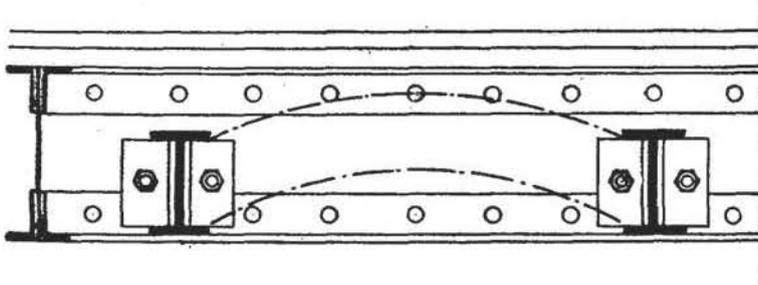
Ensambladura de las viguetas con la viga maestra: caso de bovedillas con piso de entarimado.
